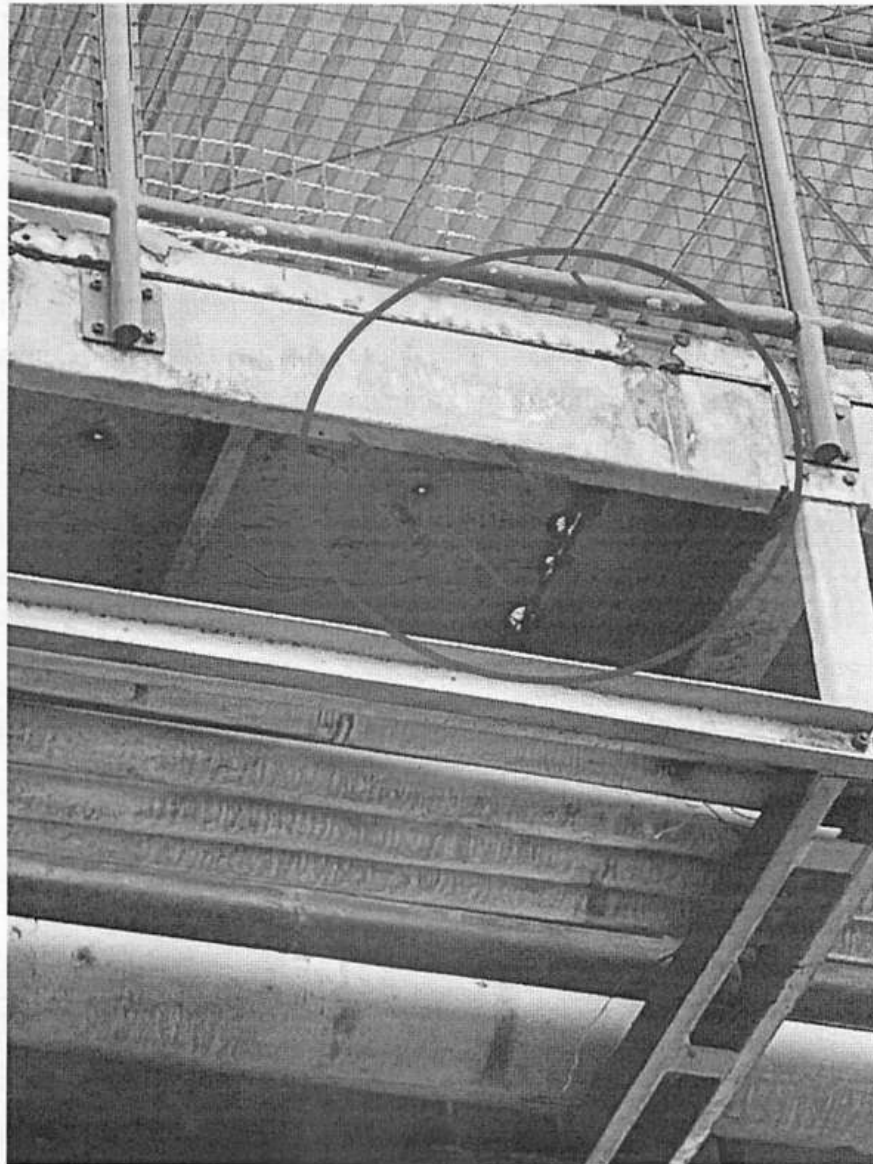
Vista de baixo da ponte, sinais severos de corrosão nas chapas metálicas da passarela e vigas de cantoneira.
